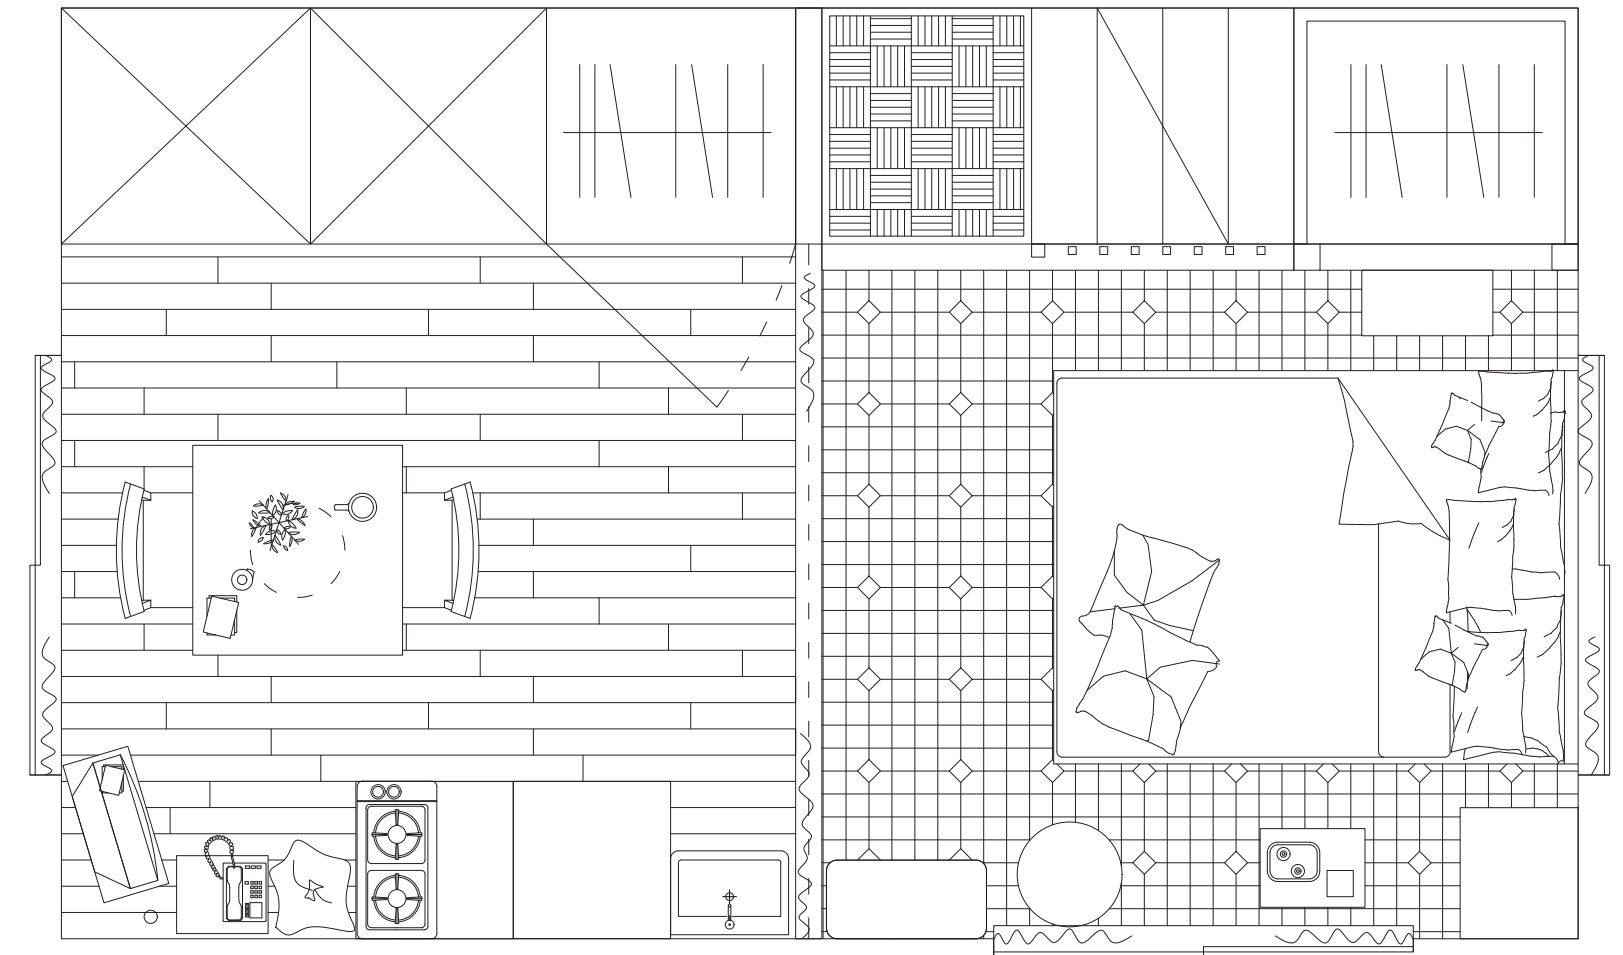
(Air Doll) Mise en dessin du plan du logement 1:20
